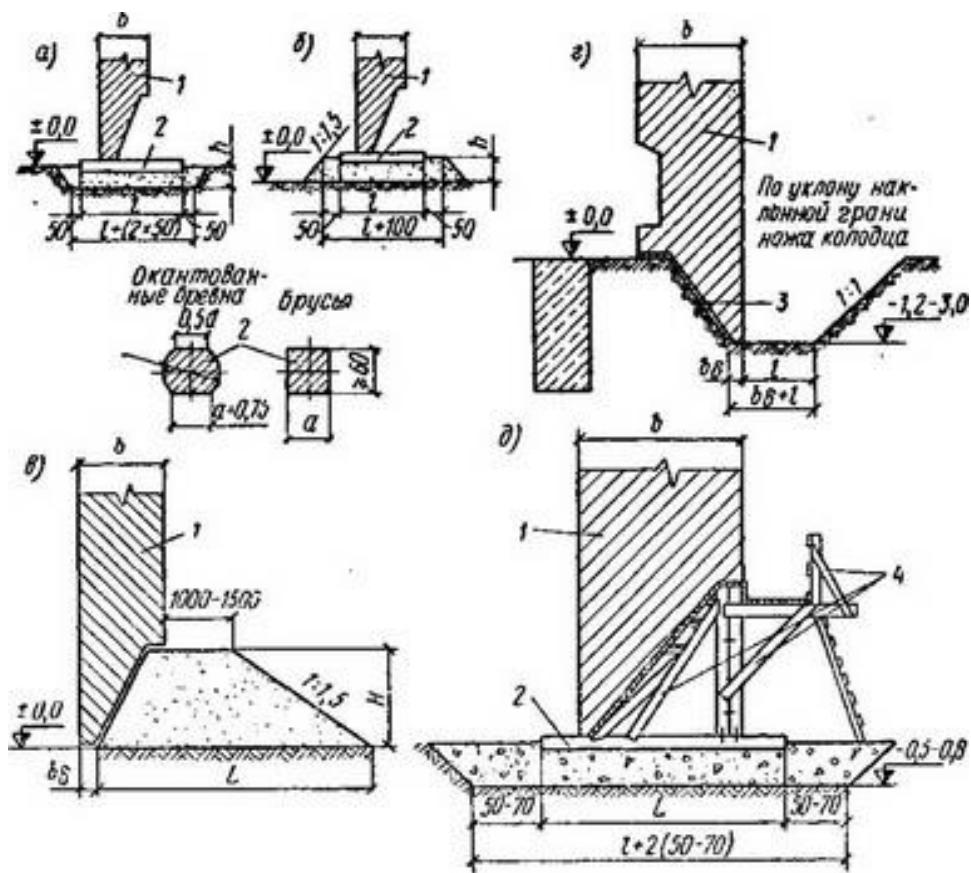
Схема подготовки оснований под нож и установка ножа опускного колодца:
